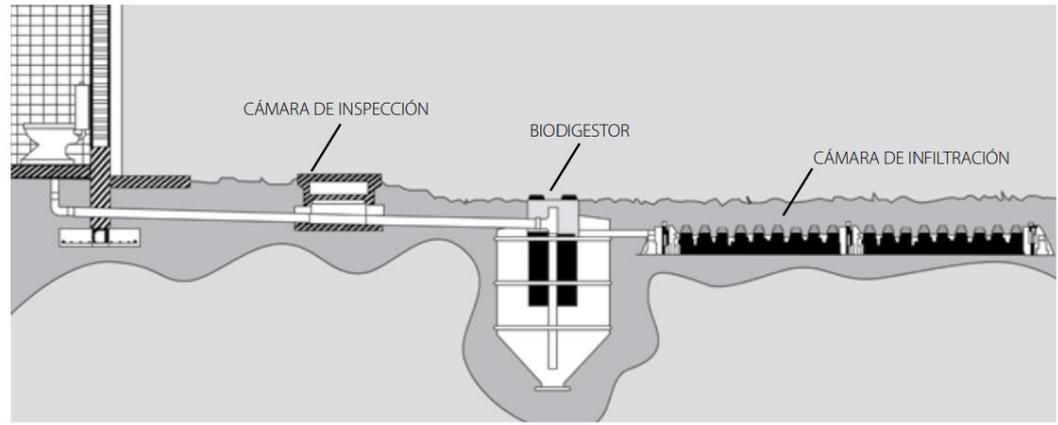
Esquema de instalación del Biodigestor autolimpiante.
